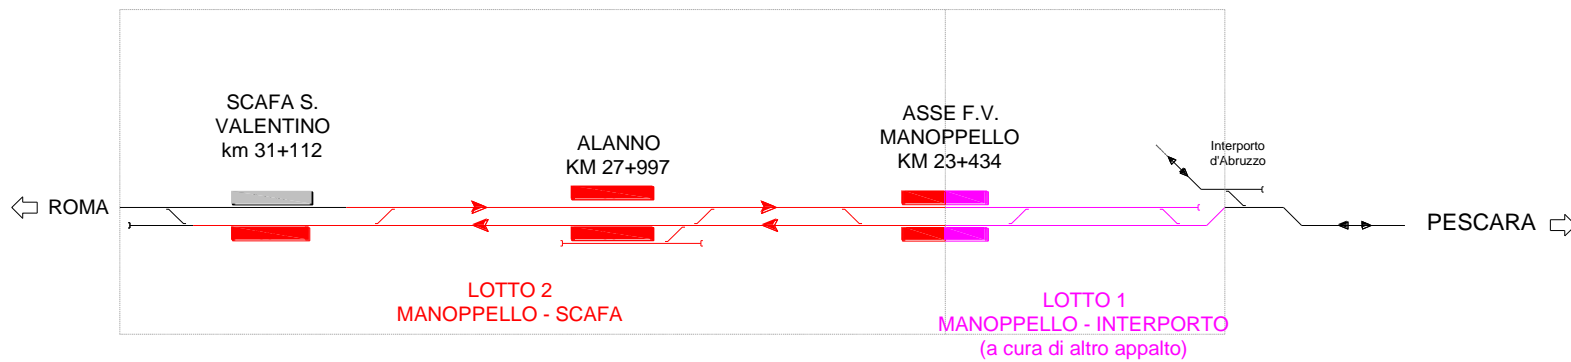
Layout di progetto: Raddoppio completo Lotto 1 (a cura di altro appalto) e Lotto 2
